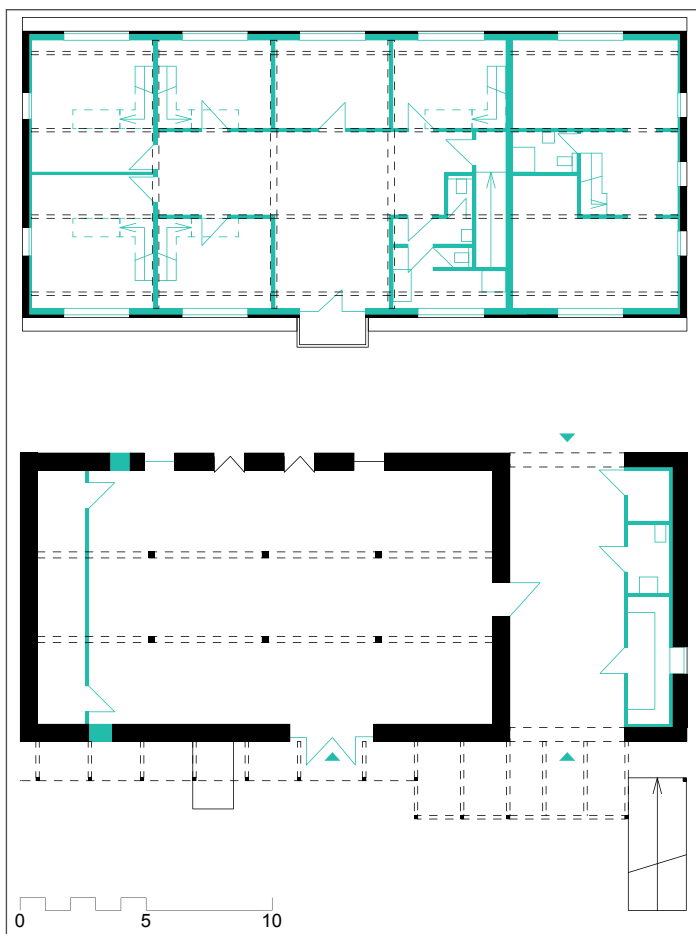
Grundrisse des EG (unten) und des 2. OG (oben) der Scheune mit den geplanten Umbauten (grün) © Wolfgang Hofmann, Bearbeitung subsolar
